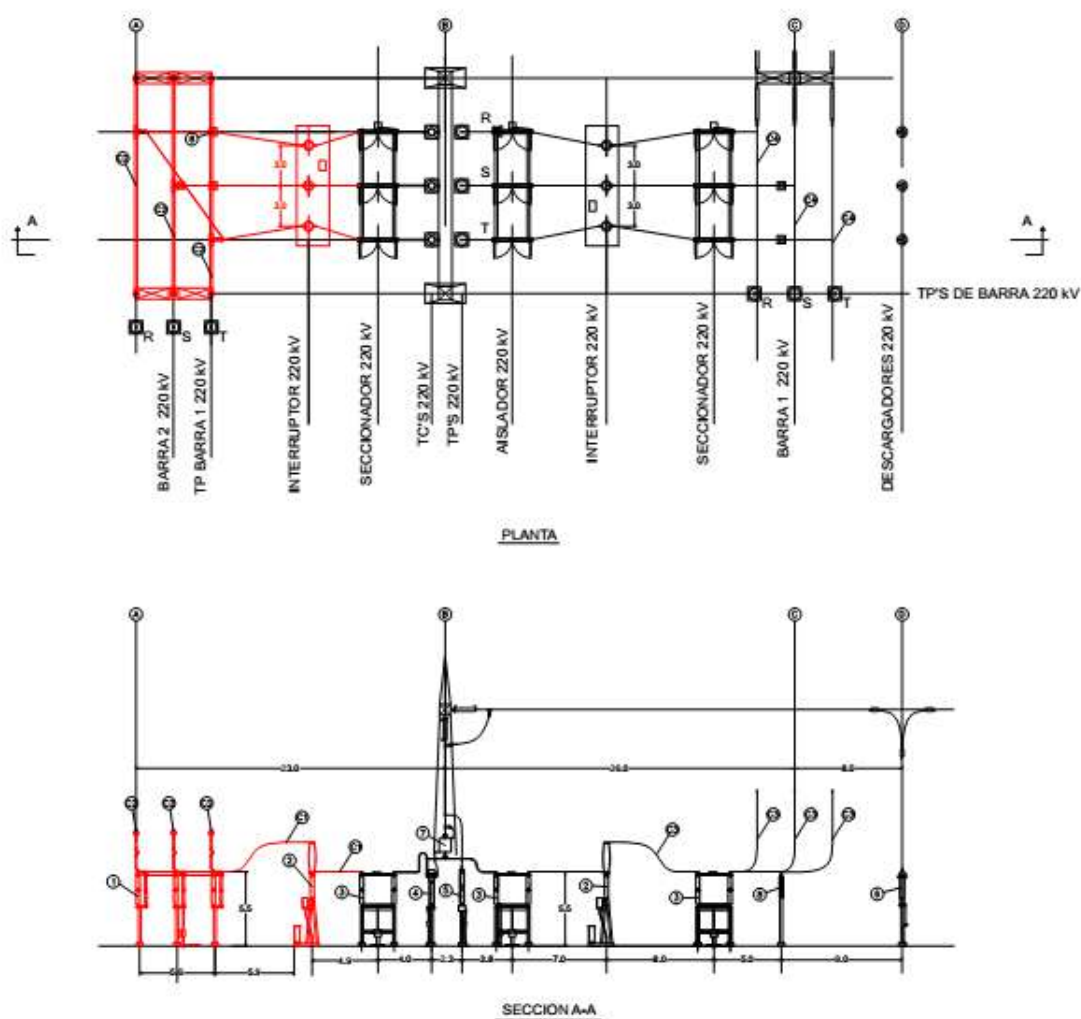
Planta y sección de la configuración doble interruptor para una posición
